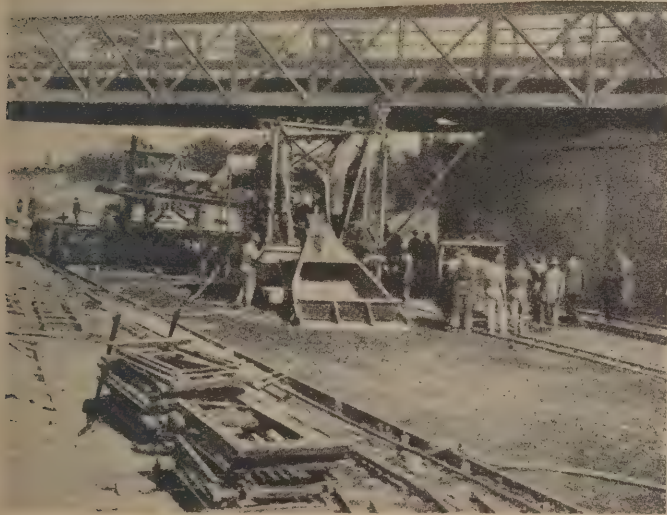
Mischmaschine und eiserner Fachwerkträger zum Profilieren der Straßendecke.
